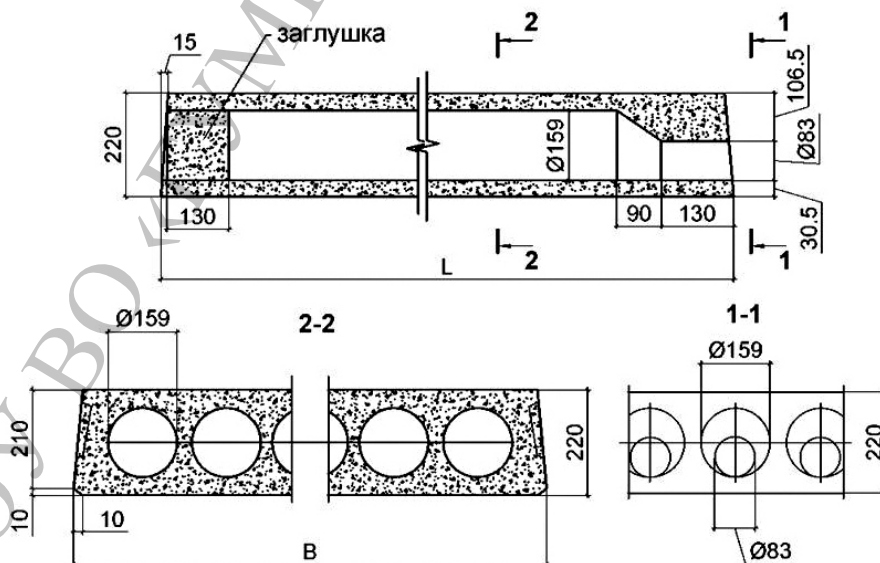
Плита перекрытия железобетонная многопустотная (ГОСТ 9561-91)
